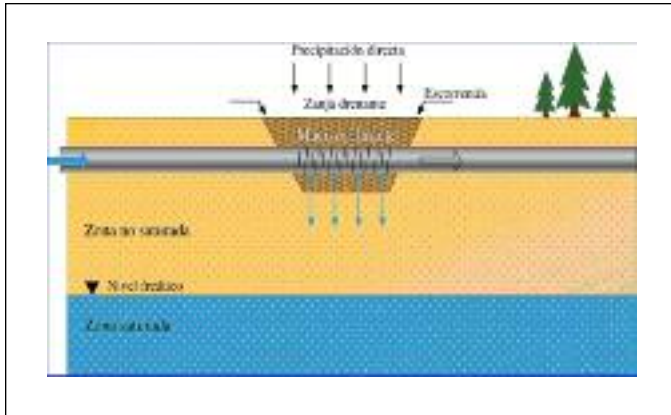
Dispositivo genérico para la recarga artificial desde una tubería ranurada enterrada en dispositivo tipo zanja drenante. Tomado de Fdez. Escalante, 2009.
